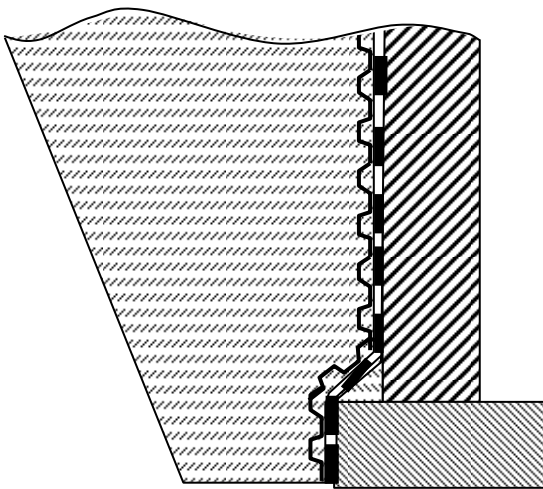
Coupe de mise en œuvre étanchéité + DRAINAX (cas où le drainage n'est pas obligatoire, ou le remblai est drainant si le drainage est obligatoire)
